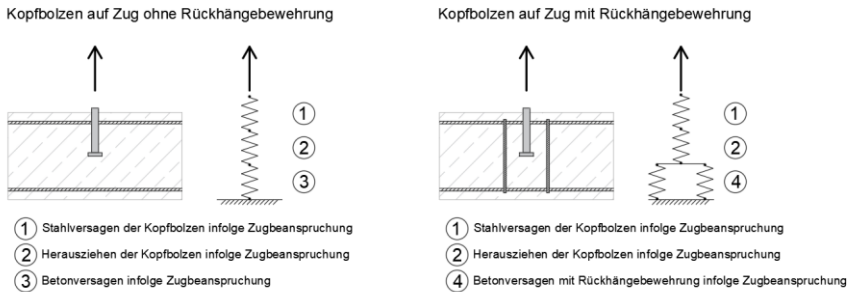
Federmodell für das Tragverhalten des Betons für Kopfbolzen mit und ohne Rückhängebewehrung
